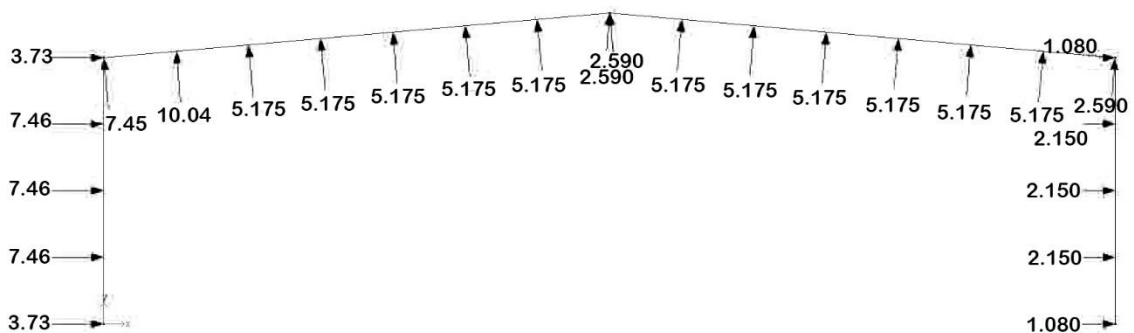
Esquema das cargas aplicadas no pórtico devido ao vento transversal, com cobertura a sucção.
